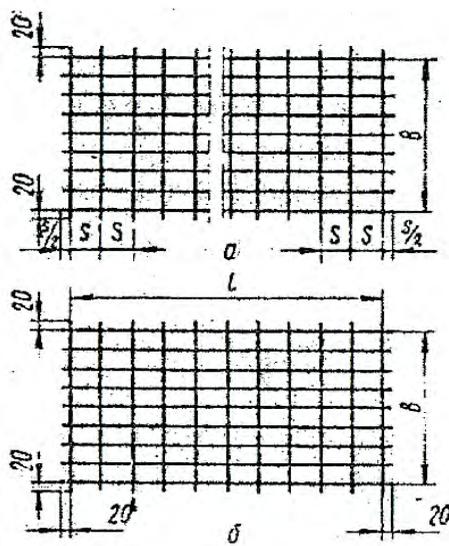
Рулонная (а) и плоская (б) сварные сетки армирования железобетонных конструкций
